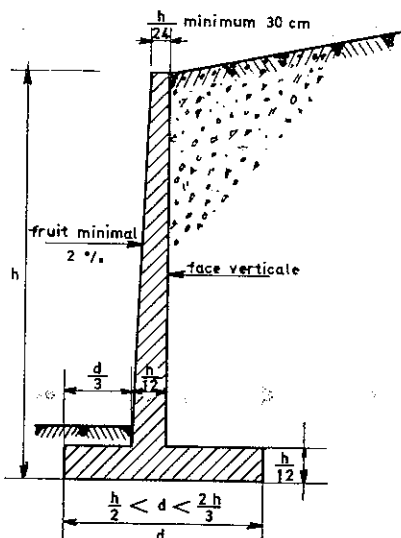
Dimensions usuelles d'un mur de soutènement en béton armé.
